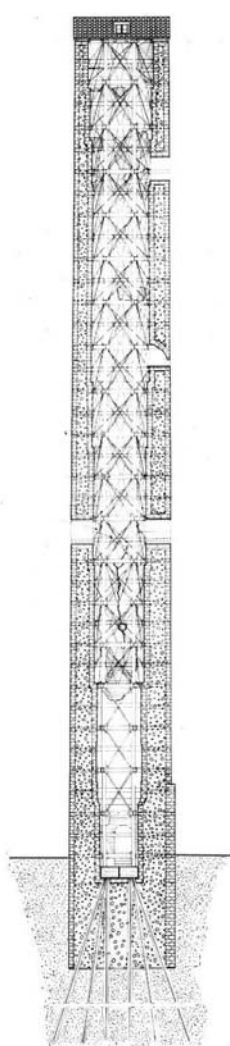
Torre di S. Dalmazio a Pavia: sezione verticale con la torre metallica interna.
